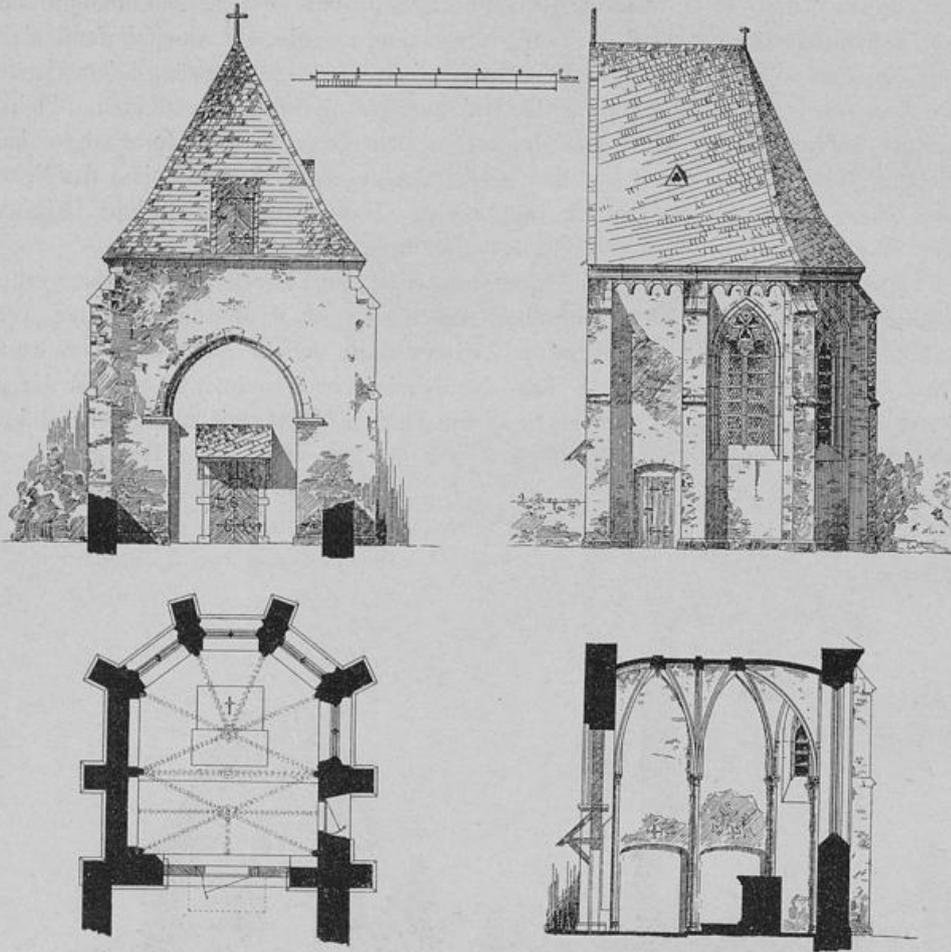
Welling. Grundriss, Schnitt und Aufrisse des Chores der alten Kirche nach der Herstellung.
